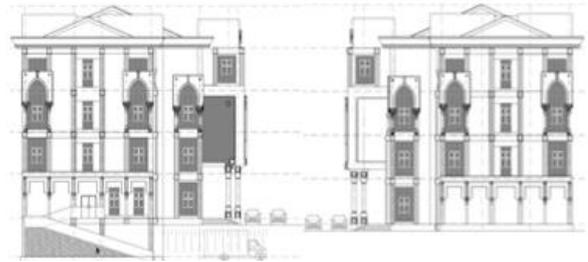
Tampak Depan Bentuk Simetri pada fasad Wisma Raodah (sumber : Heryanto Bakri, 2023)
